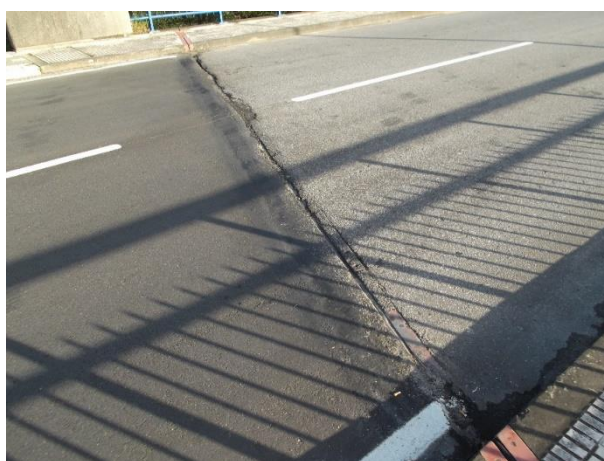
Pavimento colocado por cima de junta de dilatação
